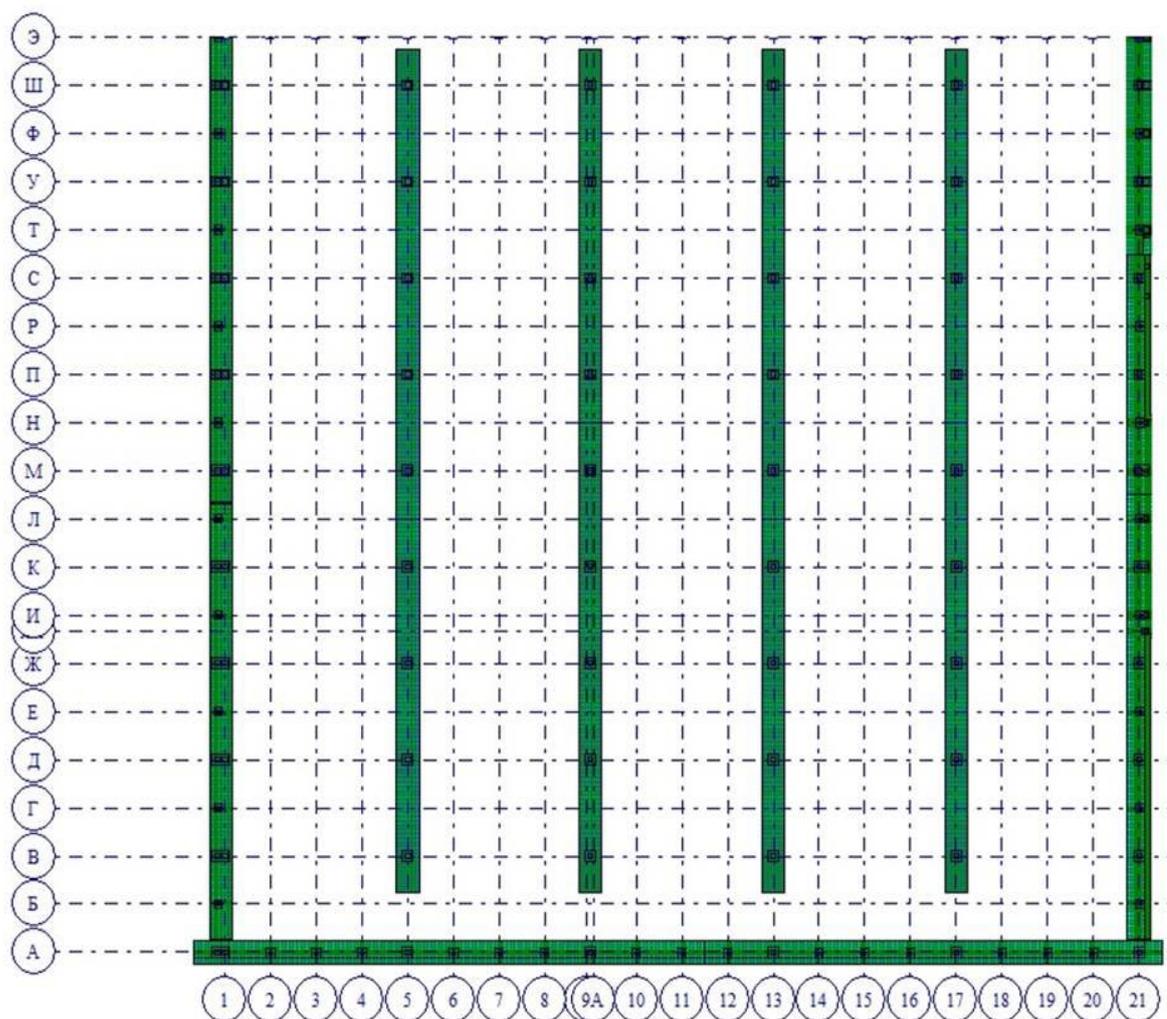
Картина давления фундаментных лент основного склада на основание от РСН2 (колонны склада)
